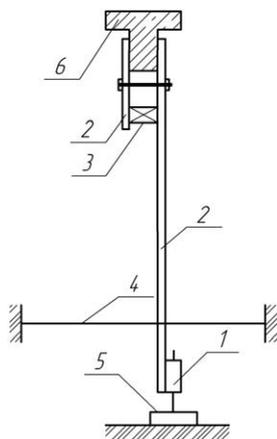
Схема установки индикатора при удаленных измерениях перемещений: 1 – индикатор; 2 – рейки-удлинители; 3 – деревянный брусок; 4 – проволочная растяжка; 5 – опора; 6 – конструкция
